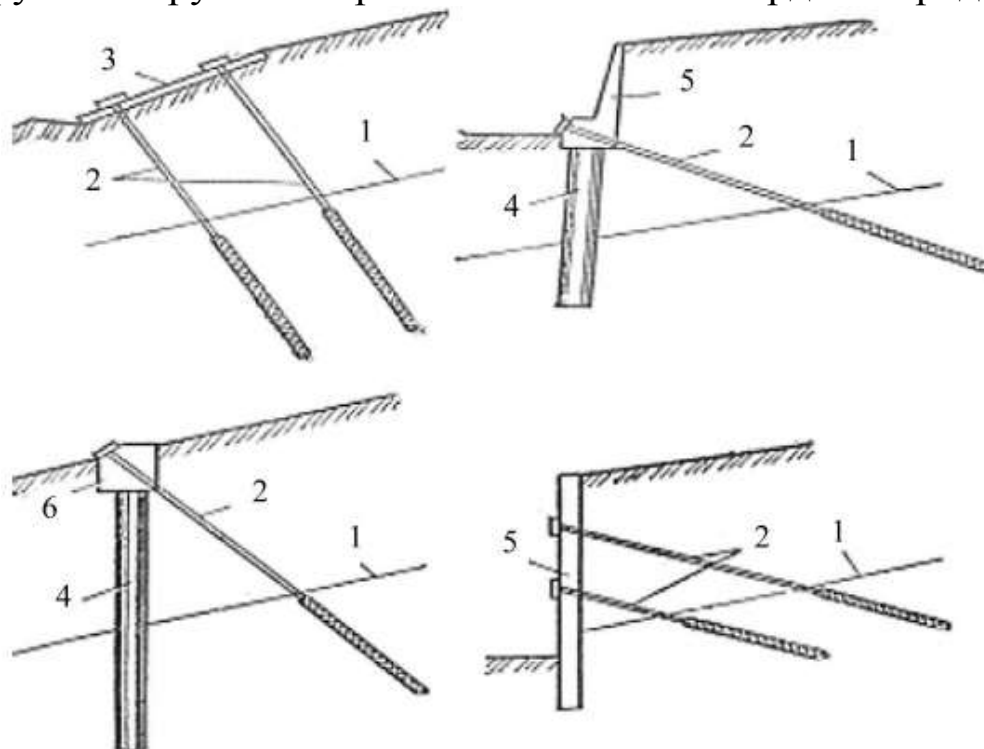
Схемы комбинированных устройств: 1 – предполагаемая поверхность сдвига; 2 – анкерное устройство; 3 – железобетонная плита (подпорная стенка); 4 – железобетонная свая; 5 – подпорная стенка; 6 – железобетонный ростверк (столб)
